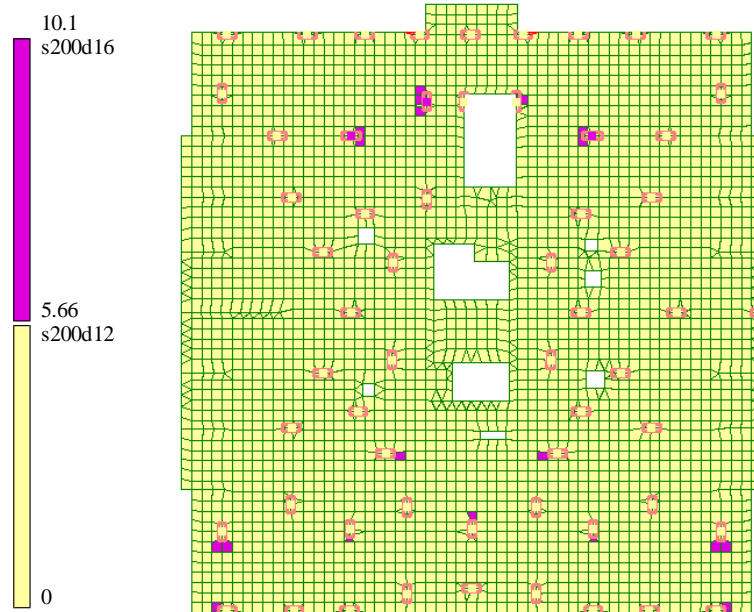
Площадь арматуры на 1 п.м. по оси X у верхней грани
